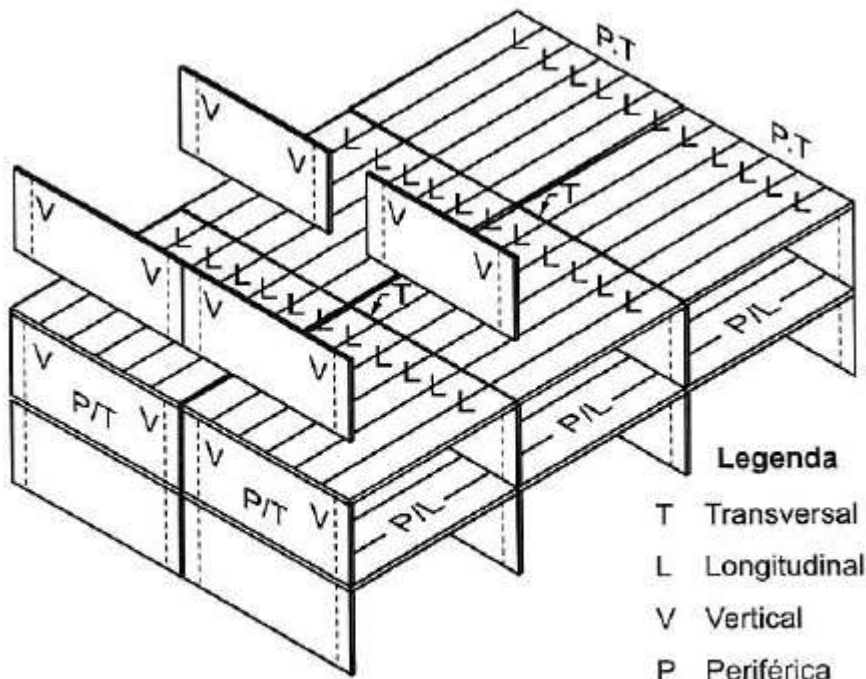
Tipos de amarração em estruturas de painéis de parede estruturais pré-moldados
